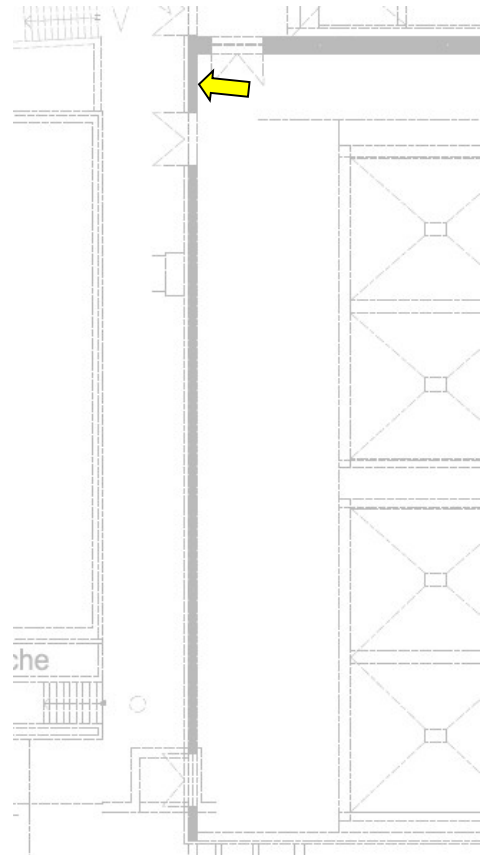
Brandschutzklappe Lage in der Halle VK Süd
